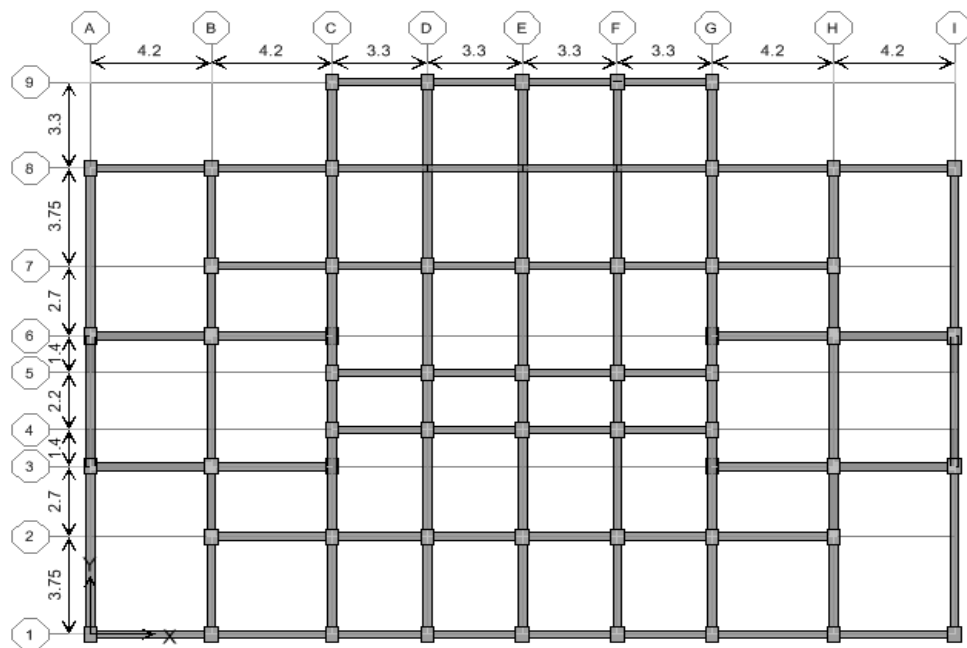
Vue en plan du RDC et du 1^{er} étage
